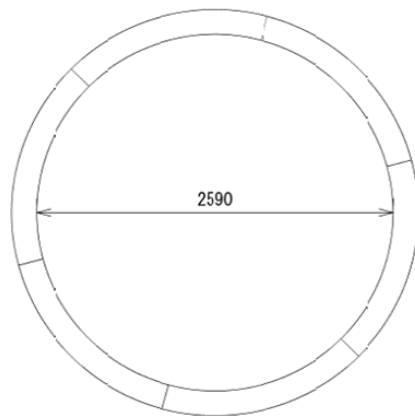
放水トンネル断面図（鉄筋コンクリート造）
